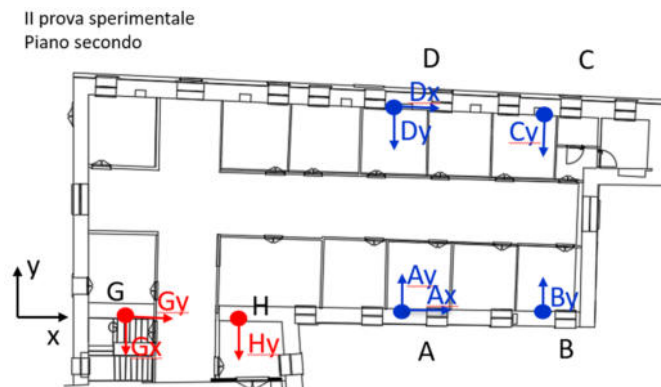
Disposizione degli accelerometri nel piano secondo dell'edificio.
